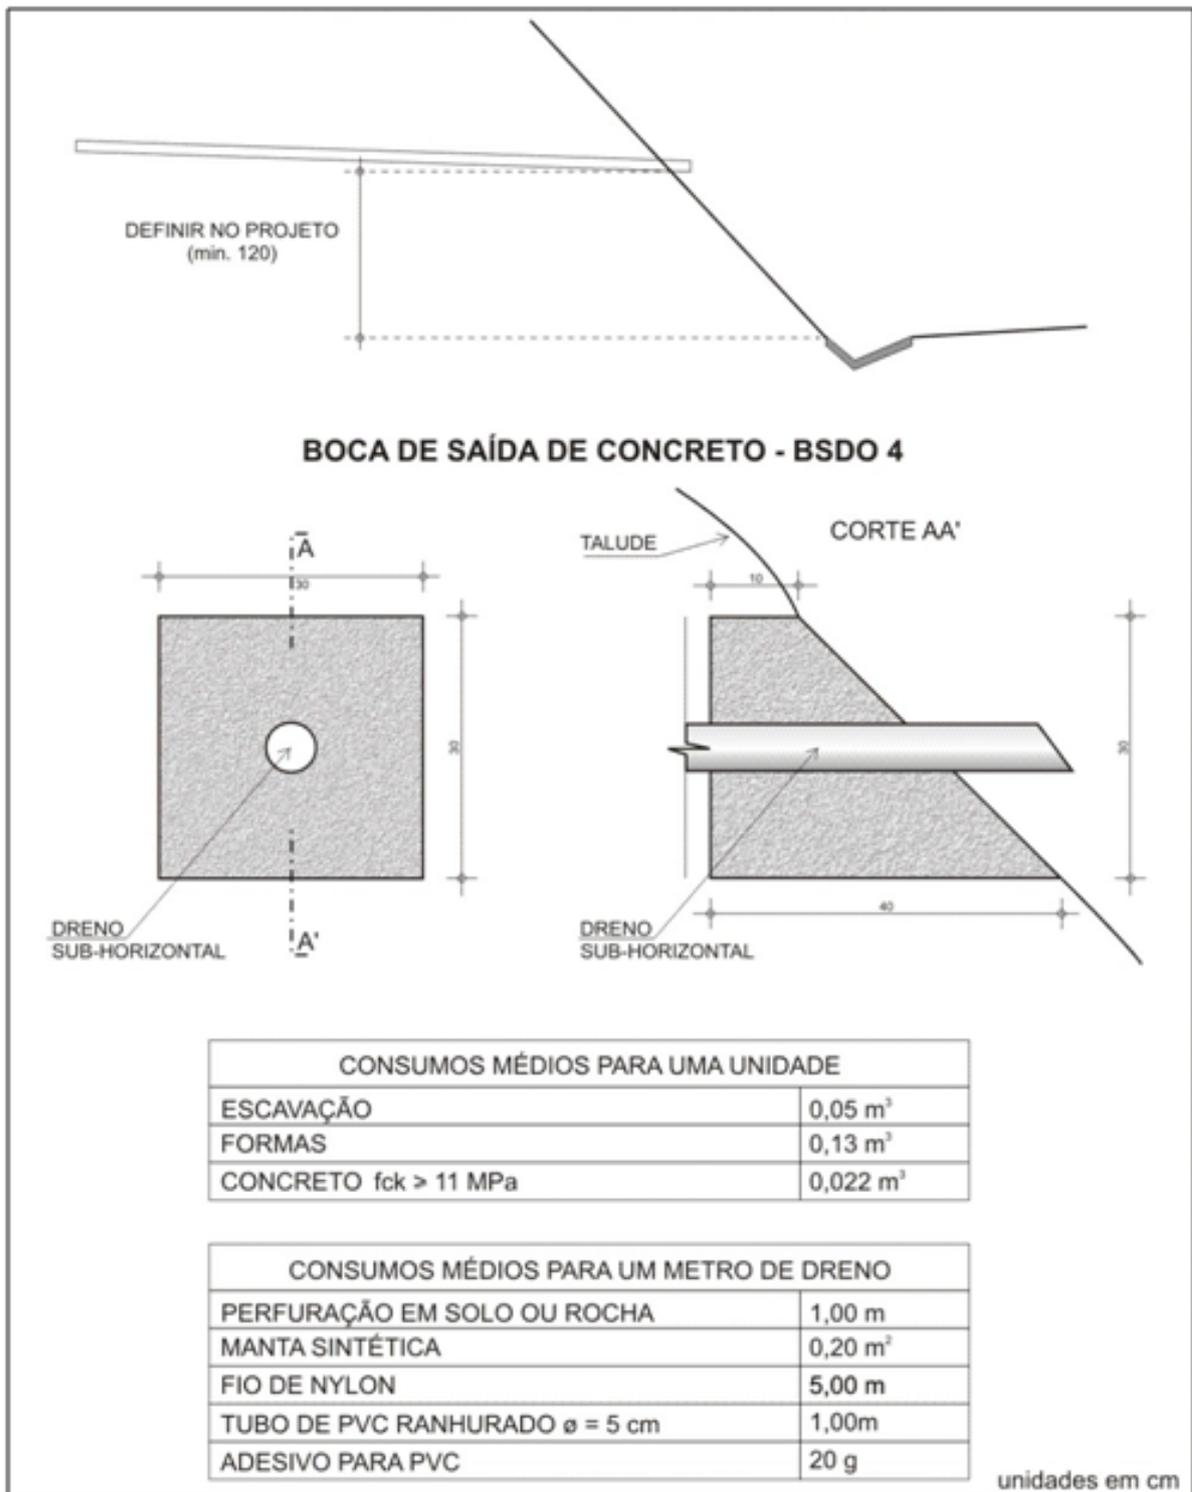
Dreno Sub-Horizontais e Detalhes Complementares – DSH01
